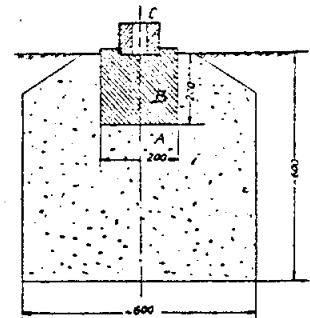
Cimentación para el dispositivo de percusión; corte vertical. Dimensiones en mm.
